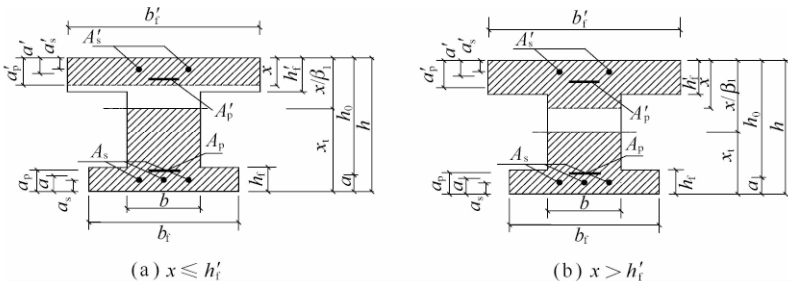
钢筋钢纤维混凝土 I 形截面受弯构件正截面承载力计算
